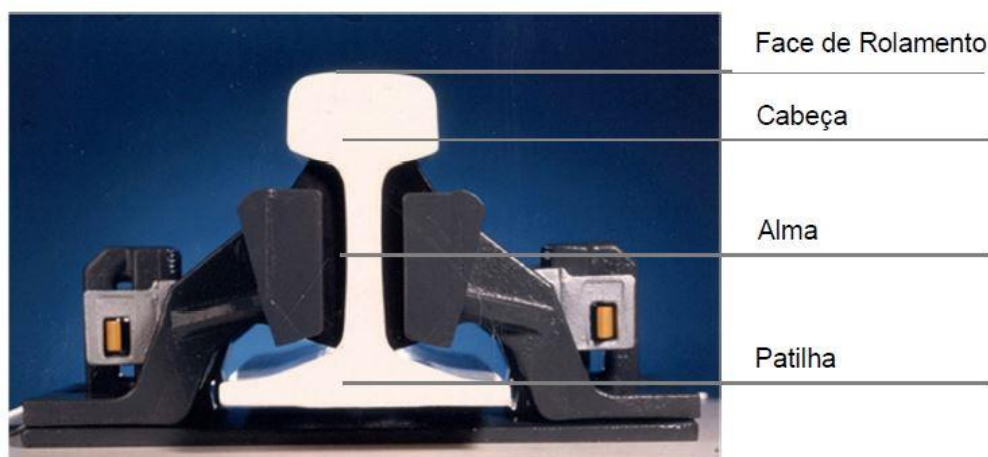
Esquema das secções do carril (Adaptado de: (8))
